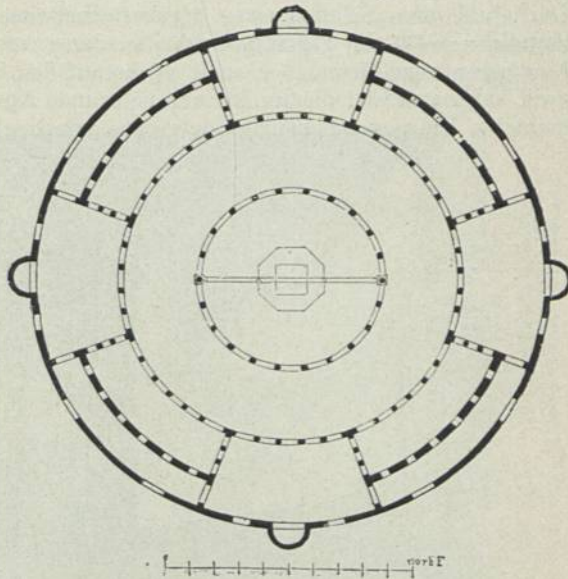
Grundriss von S. Stefano rotondo in Rom
